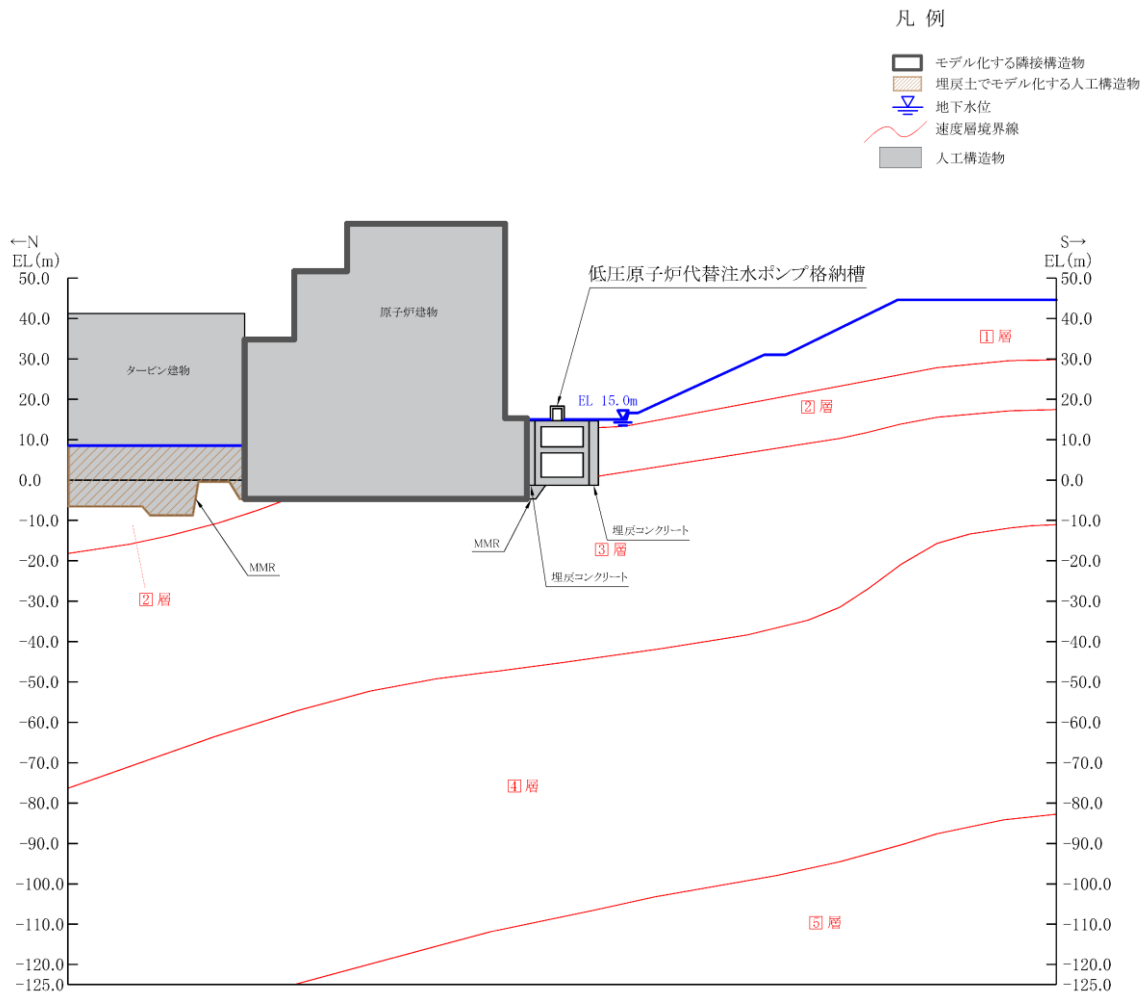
低圧原子炉代替注水ポンプ格納槽断面図 (A-A 断面位置)
